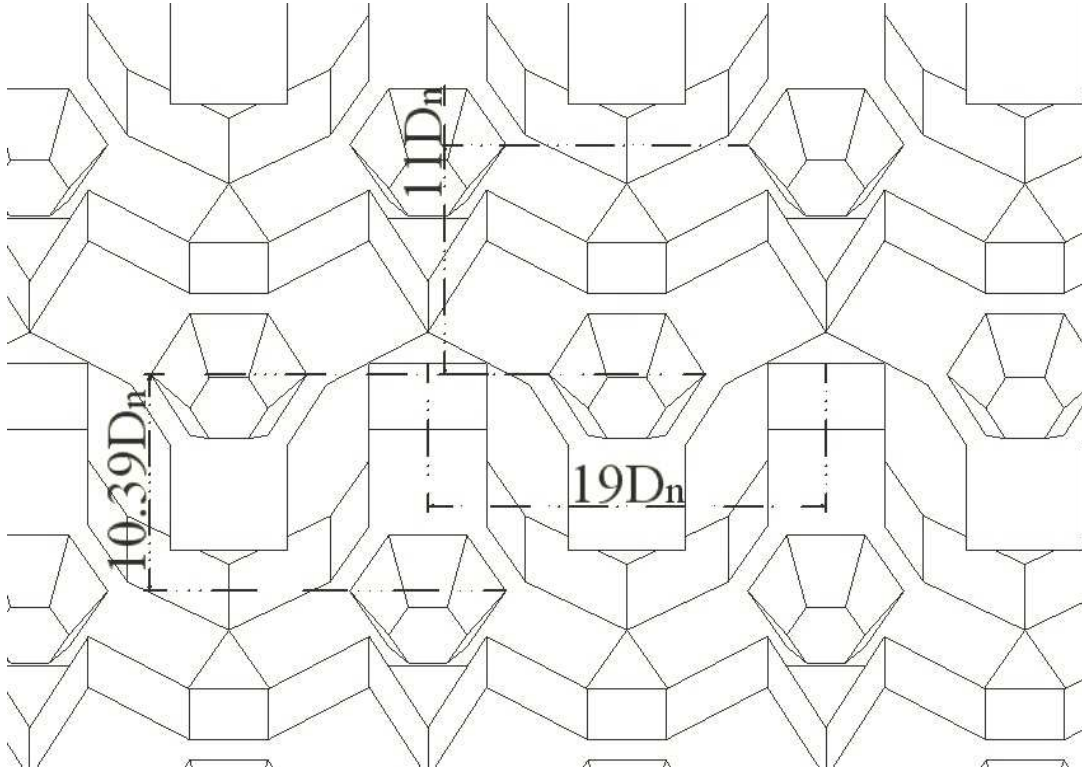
Vue du plan de pose 4 ('alternatif')
